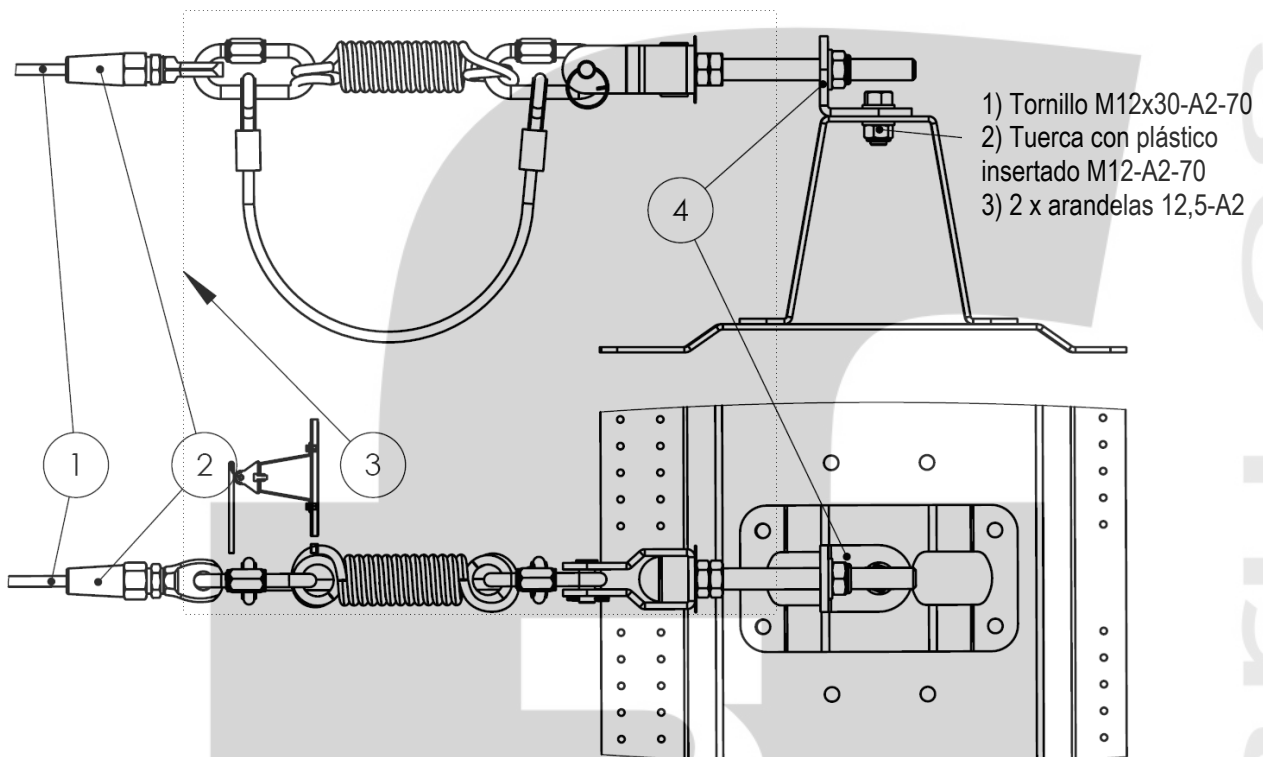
Montaje del cable, swageless y absorbedor de energía / tensor del cable al final del sistema sobre el poste para cubierta de chapa. 1- cable, 2- swageless, 3- absorbedor de energía / tensor del cable, 4- soporte en los extremos
